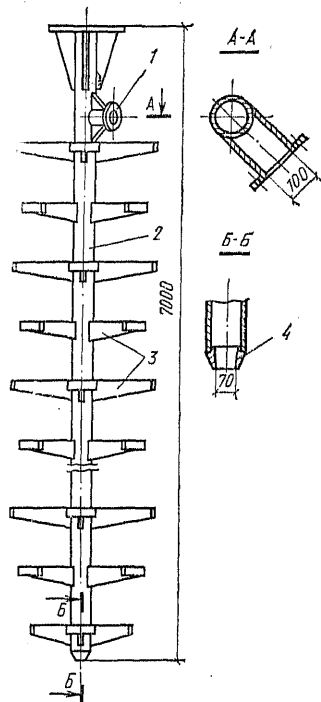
Уплотнитель виброустановки ВУУП-6 для искусственного водонасыщения песчаного грунта
